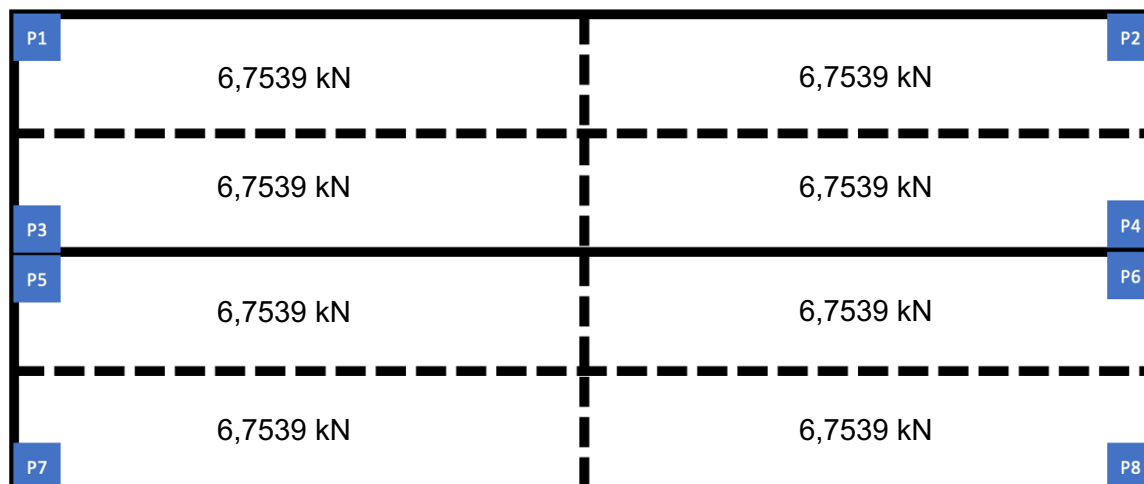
Distribució de les càrregues degudes als elements constructius del terra – planta baixa
